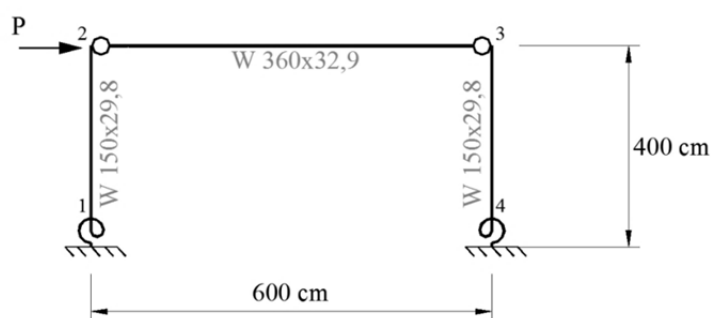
Pórtico não-contraventado de 1 andar e 1 vão com ligações de base semirrígidas.
